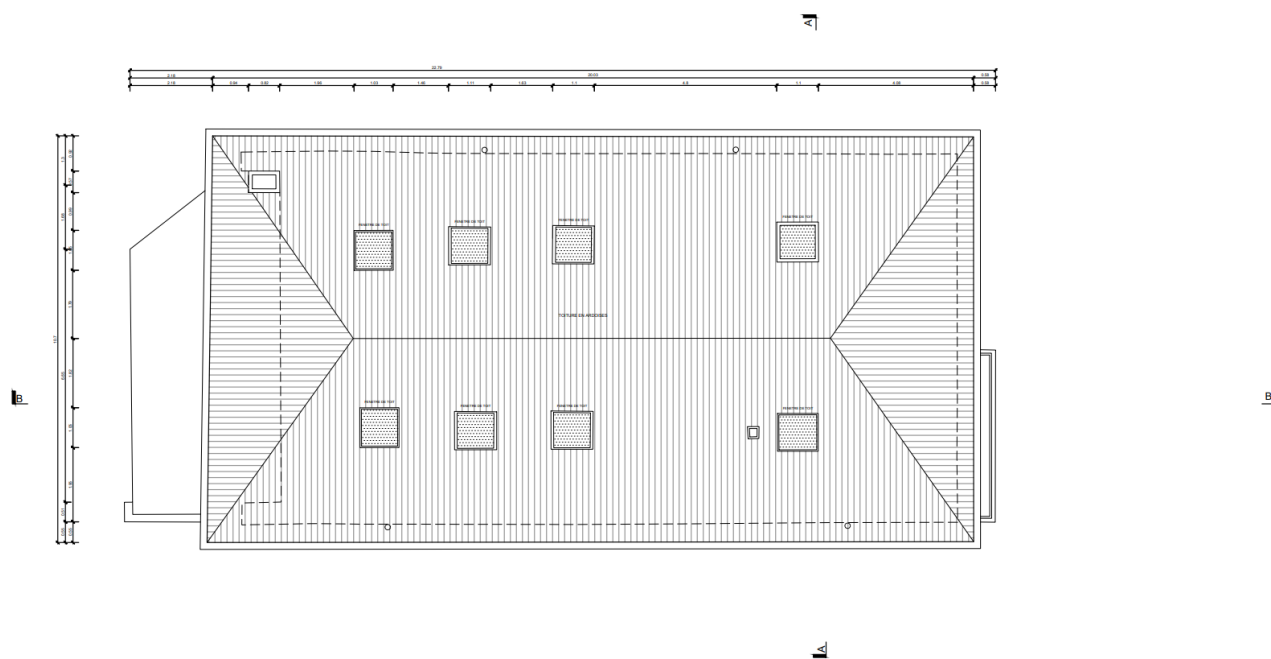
Plan toiture - (ADT, 25/08/2021, indice A)
